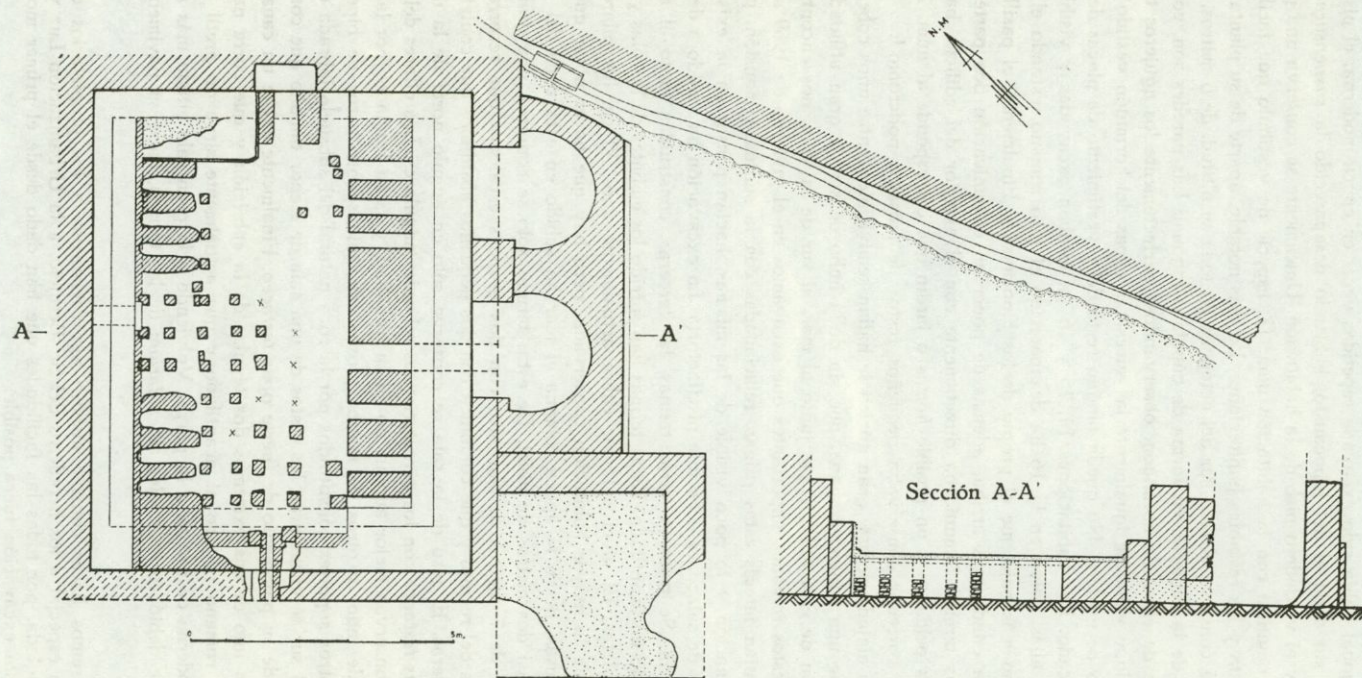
Els Munts. Termas situadas junto a la playa. Planta y Sección.
